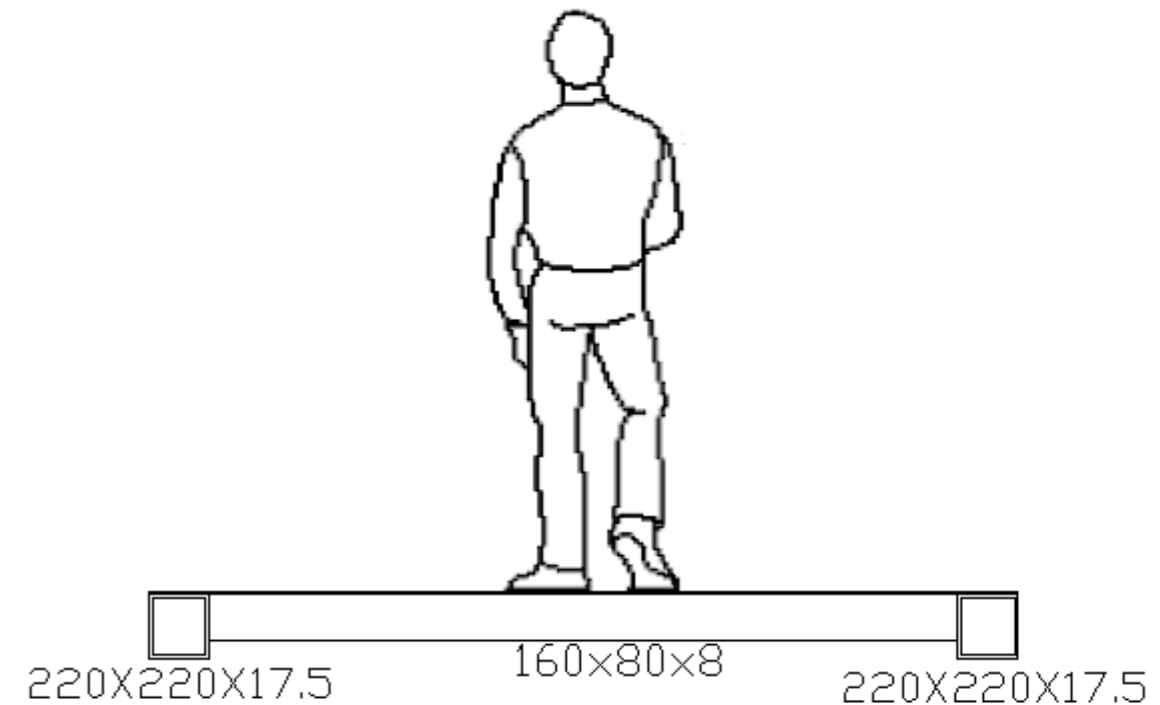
Detalle tablero pasarela peatonal tipo Warren.
